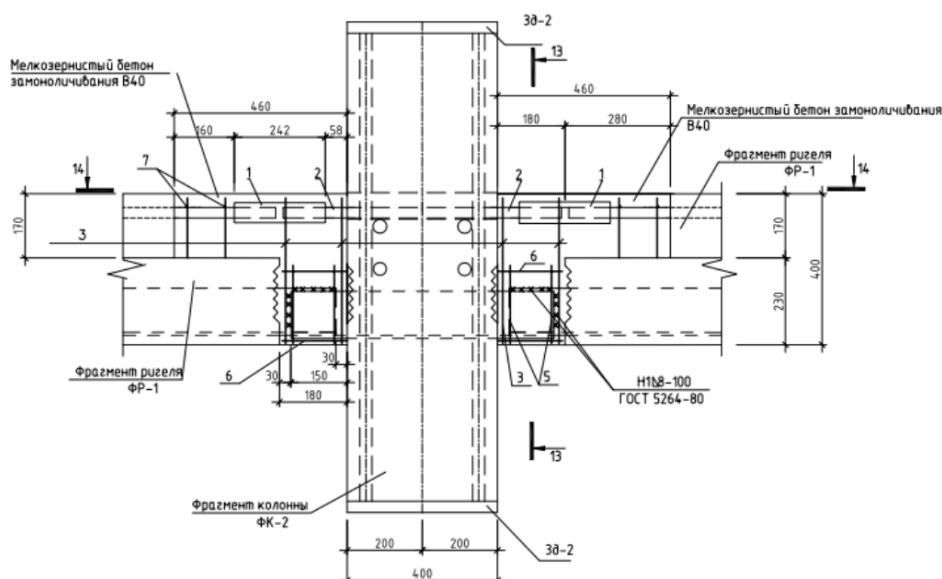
Конструкция узла сопряжения ригелей с колонной
